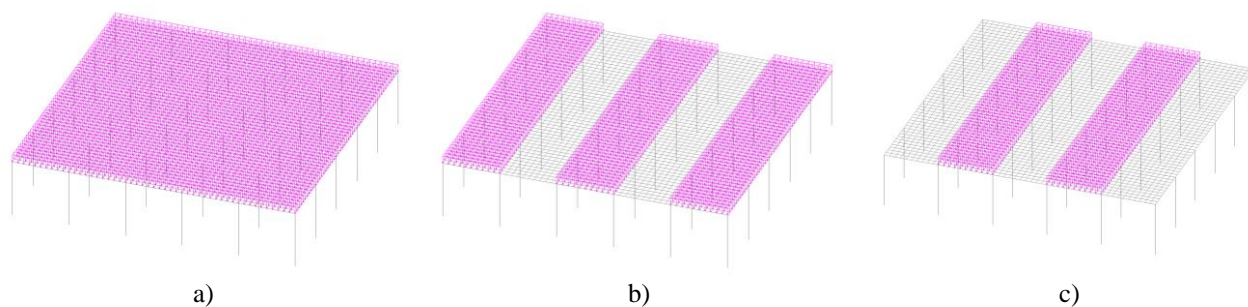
Схемы нагружения полезной нагрузкой расчетной схемы: а – нагрузка на всем перекрытии; б – нагрузка в нечетных пролетах плиты; с – нагрузка в четных пролетах плиты
